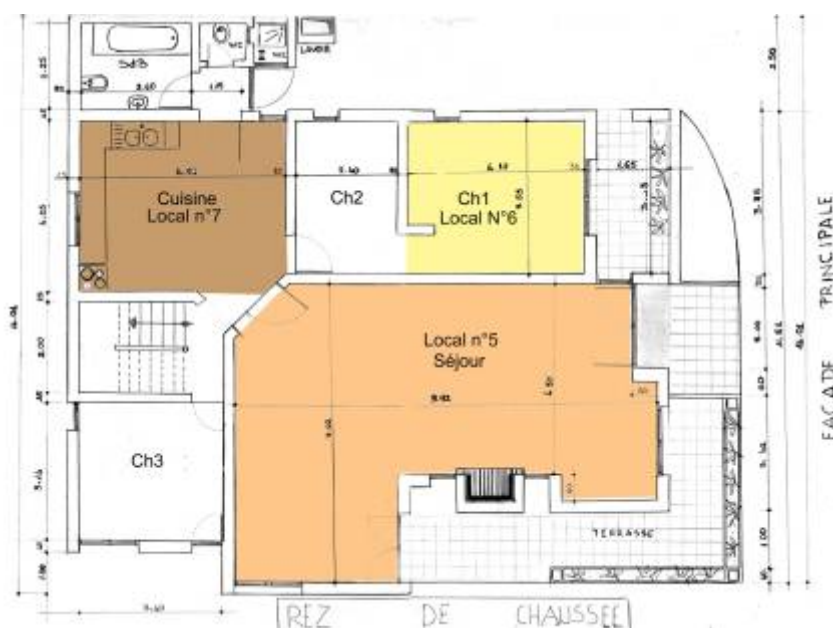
niveau rez-de-chaussée (M4, M5, M6, M7)
